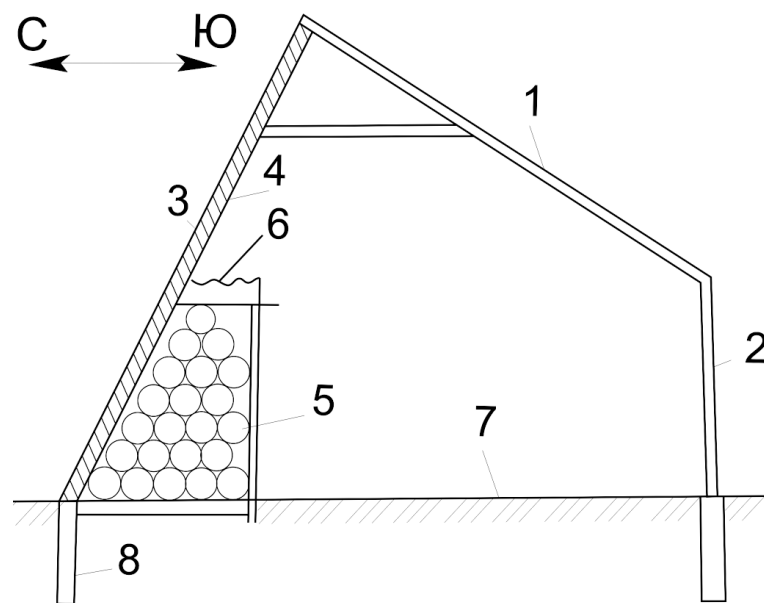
1 – прозрачная изоляция, 2 – опорная стенка, 3 – северная стена, 4 – теплоизоляция, 5 – галечный аккумулятор, 6 – ящики с рассадой, 7 – защищенный грунт, 8 – теплоизолированный фундамент.
